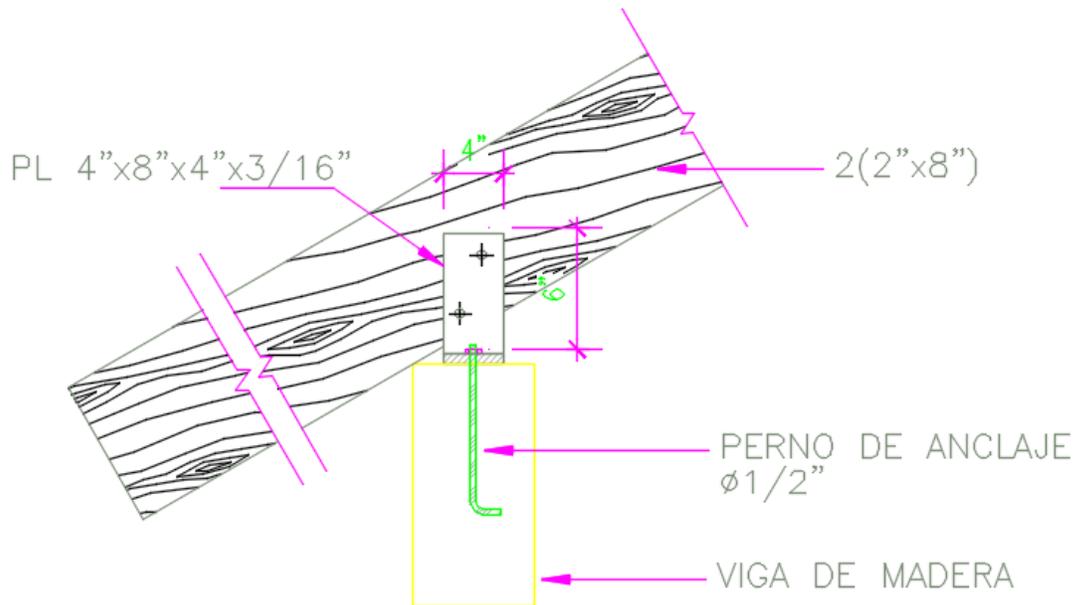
Detalle 5 de Cubierta en machimbre, elaboración propia
